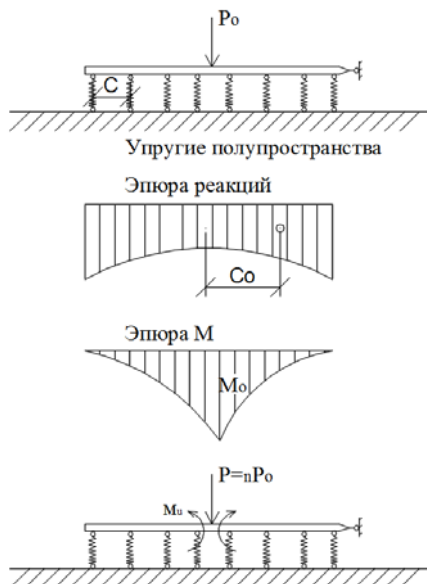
Расчетная схема балки, нагруженной силой в середине пролета
